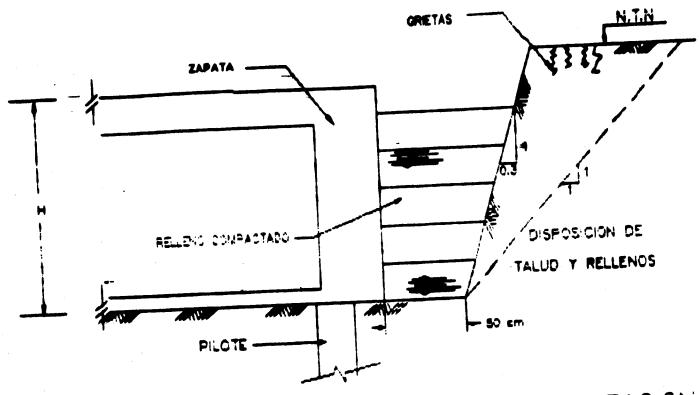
EXCAVACION EN ZAPATA DE CIMENTACION
